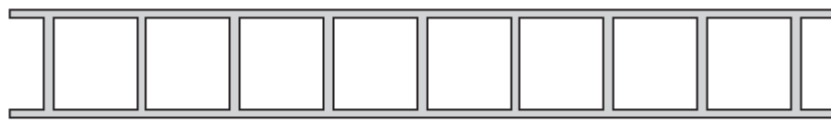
Teori dasar plat/slab. Slab bekerja secara lebih efisien daripada balok (beam) karena bersifat monolitik. Ketika satu elemen bekerja di bawah standar, elemen di sekitarnya secara tidak langsung akan membantu meningkatkannya.
